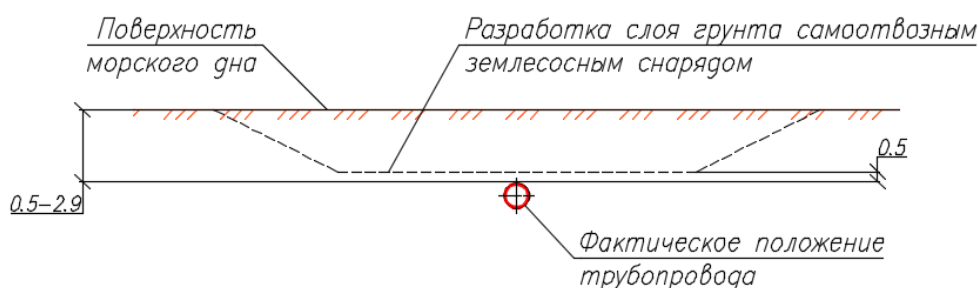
Разработка слоя грунта самоотвозным землесосным снарядом
